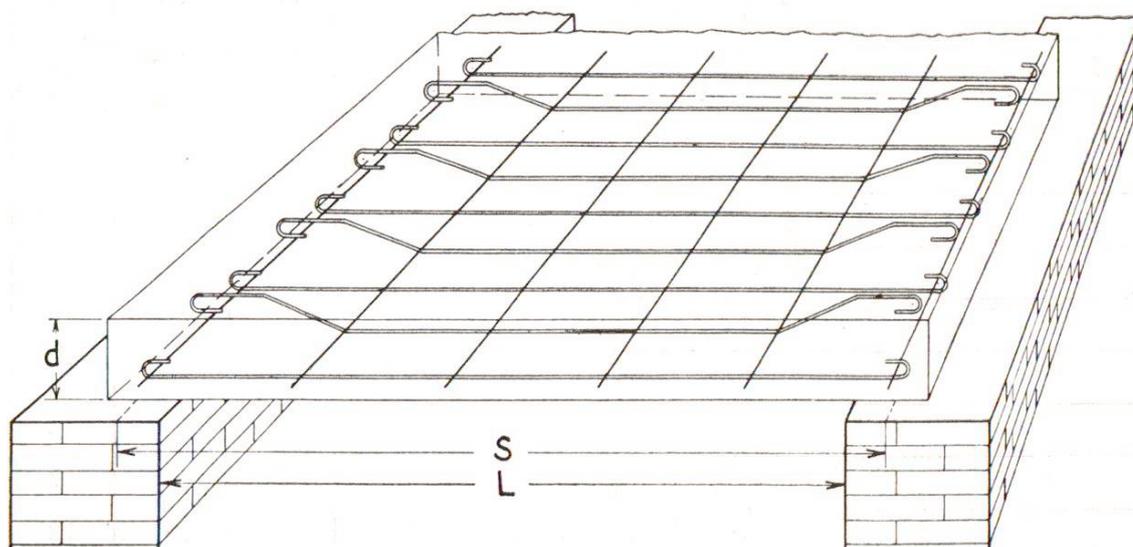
Croquis en perspective d'une dalle pleine sur appuis simples. (L = ouverture libre, S = portée, d = épaisseur de la dalle)
